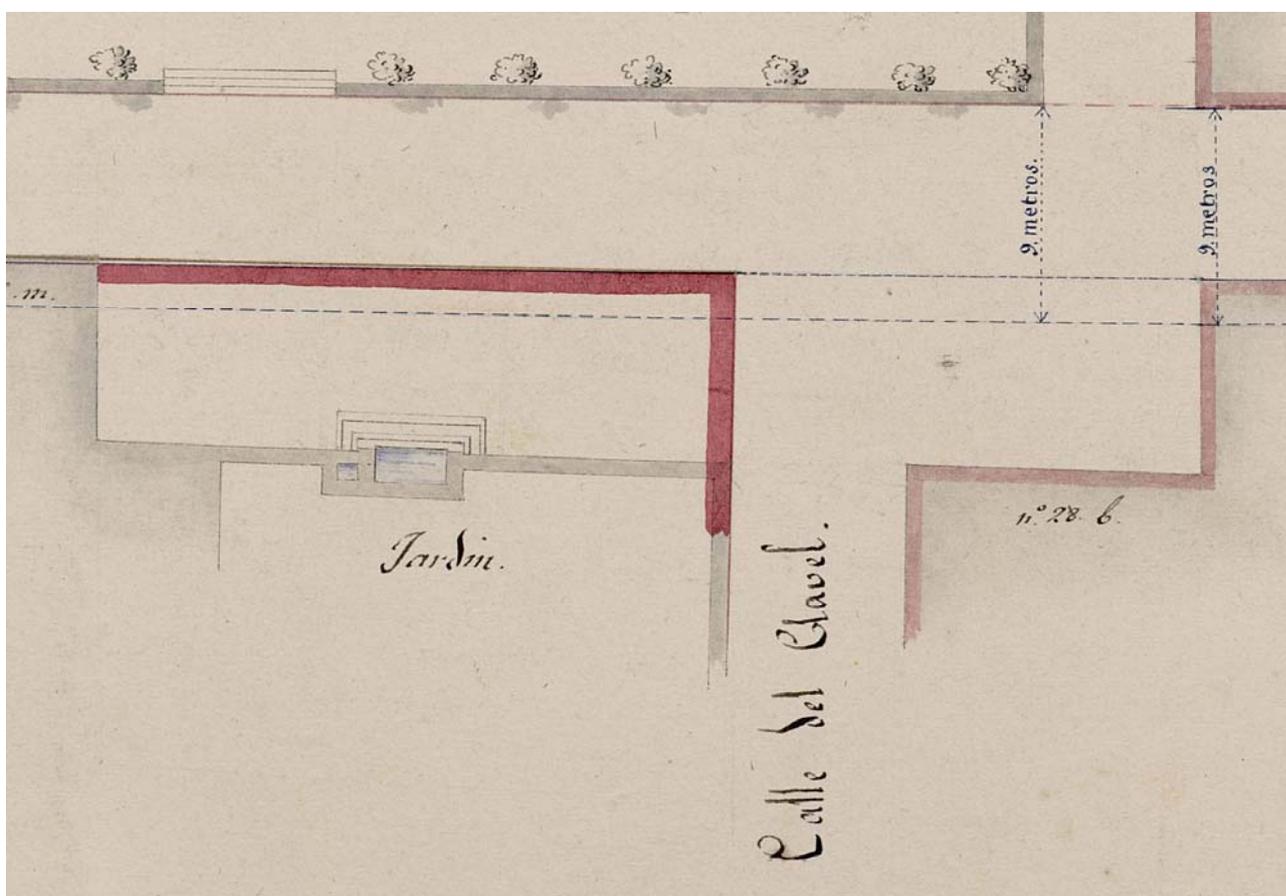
Detalle del plano anterior donde se aprecia la planta de la Fuente de Capuchinos adosada al muro de cerramiento de un jardín privado en la esquina de la calle del Clavel con la de las Infantas..
